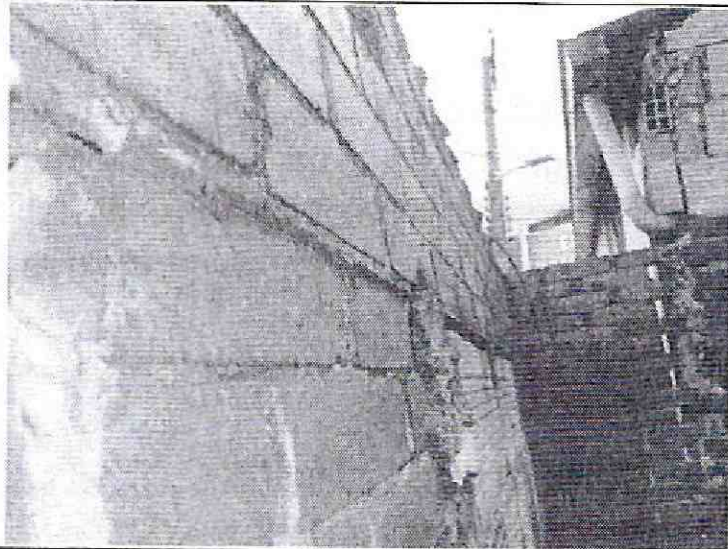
Vista interior muro fachada segundo piso. Se observa deslizamiento en pega de mortero a nivel del dintel
